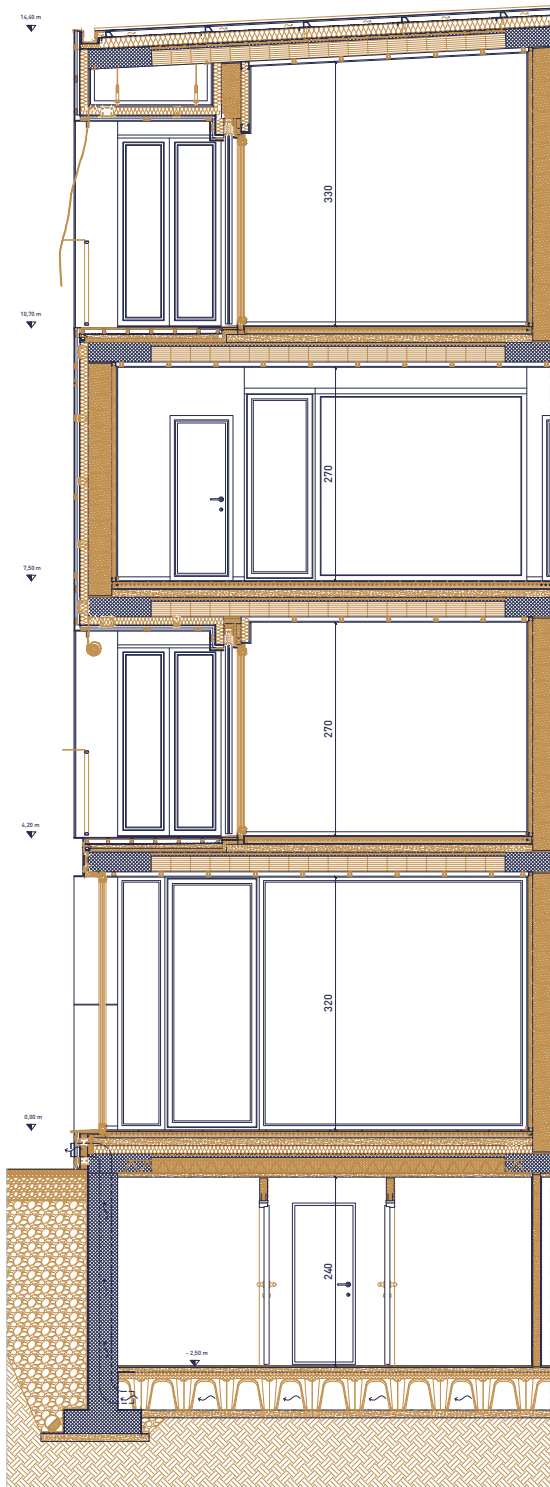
, Sezione cielo terra, prospetto, porzione della pianta, dell'edificio a blocco.
